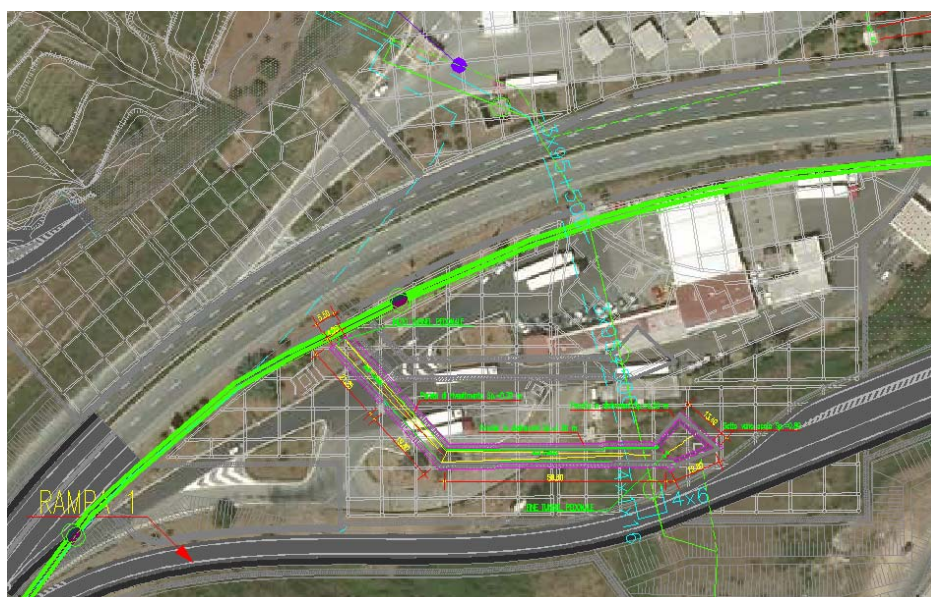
Stralcio planimetrico dell'opera con indicazione dei sottoservizi esistenti
